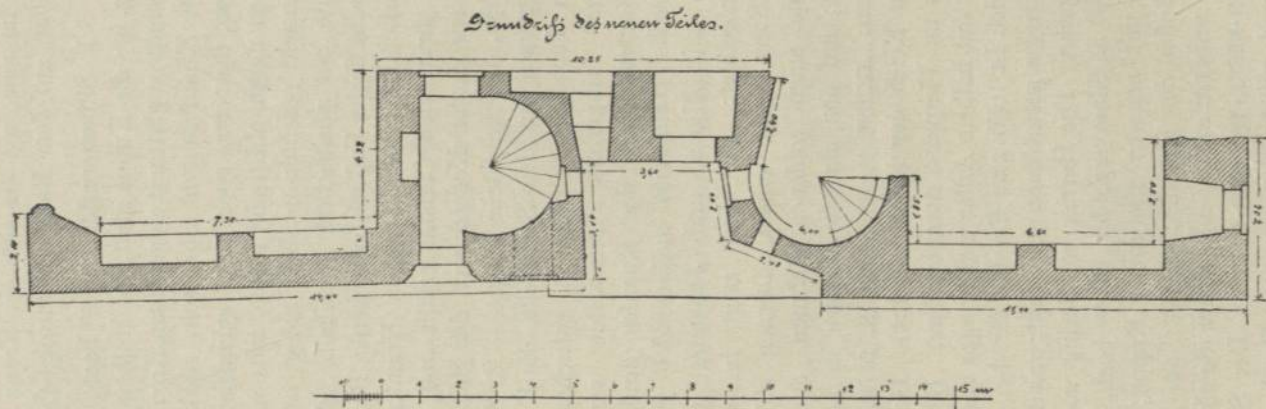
Daber; Schloß, Grundriß des Neuen Hauses.
